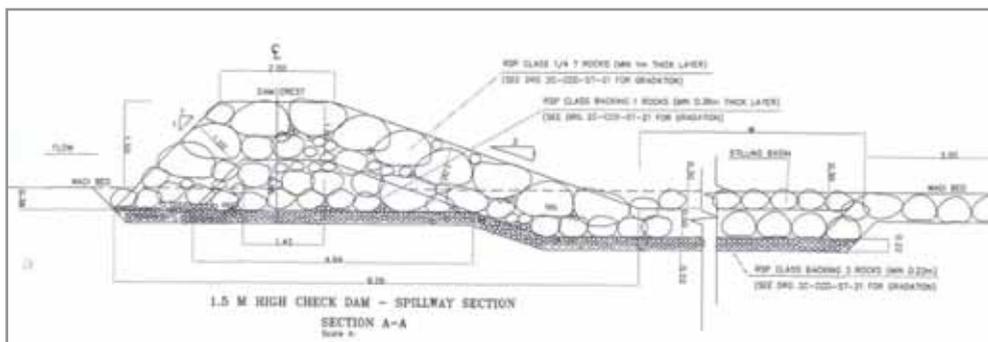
Caractéristiques d'une coupe transversale d'un barrage de retenue de 1,5 m de haut dans l'oued Qaradha, Yémen
